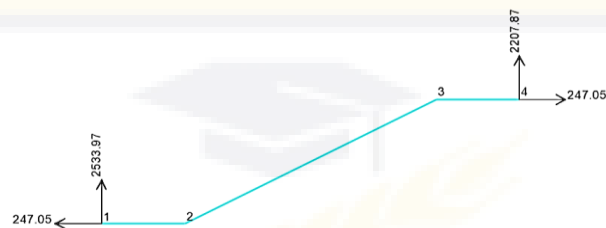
15: Pembebanan Balok Utama Tangga (SAP2000)
